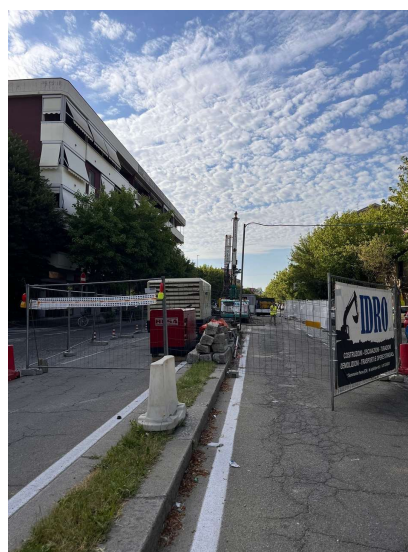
e 4 – cantierizzazione con restringimento di carreggiata su Corso Torino
